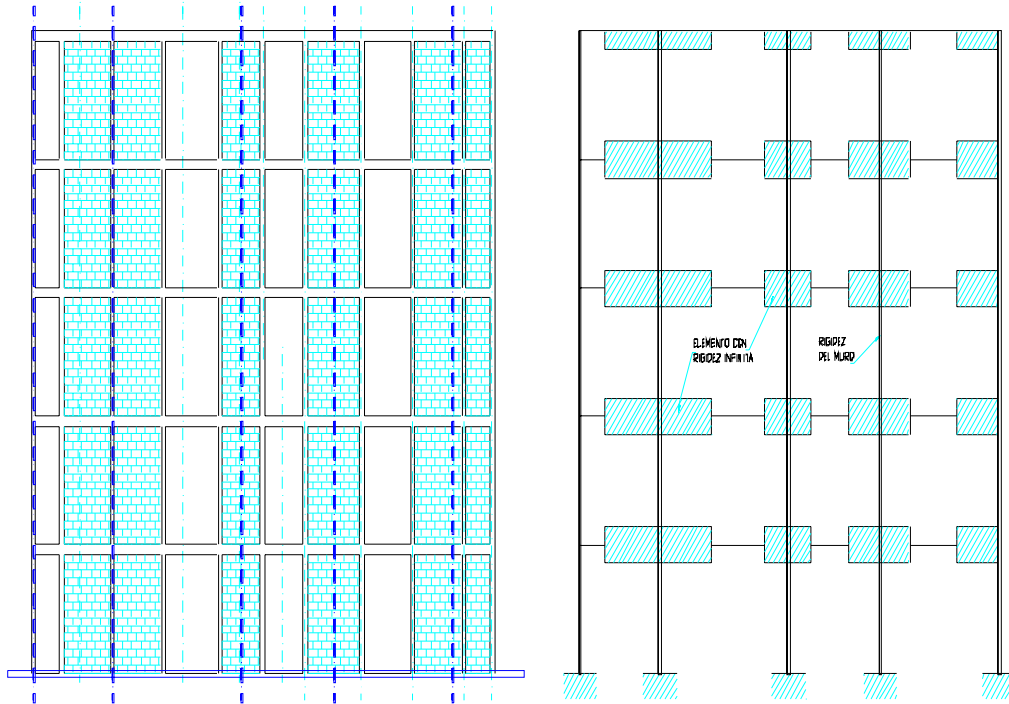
Modelo para un muro de mampostería utilizando la analogía de la columna ancha
